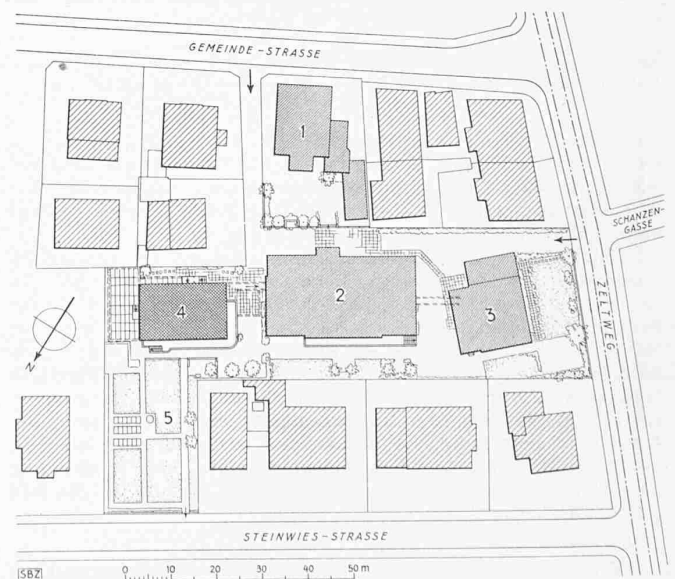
Haushaltsschule Zürich. Lageplan 1:1500. — 1 Haus Morgenthal, 2 erstes Schulhaus, 3 Logierhaus, 4 neues Schulhaus, 5 Schulgarten
